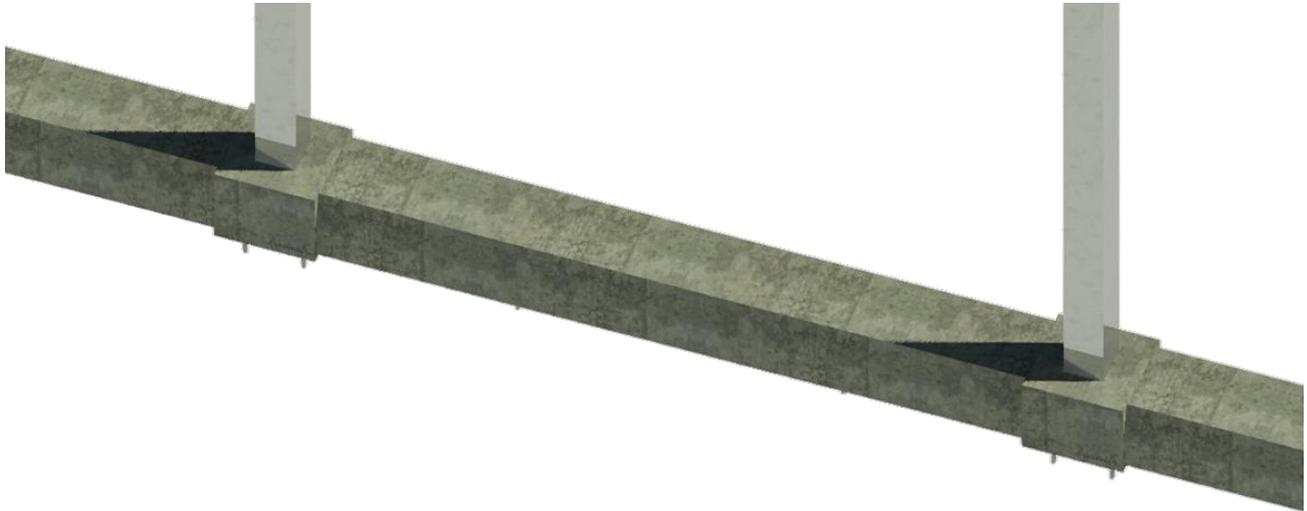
Vista longitudinal viga de cerramiento perimetral
